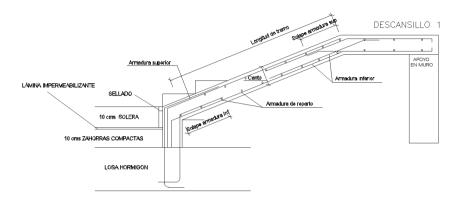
Detalle constructivo arrangue escalera. Fuente: Propia
